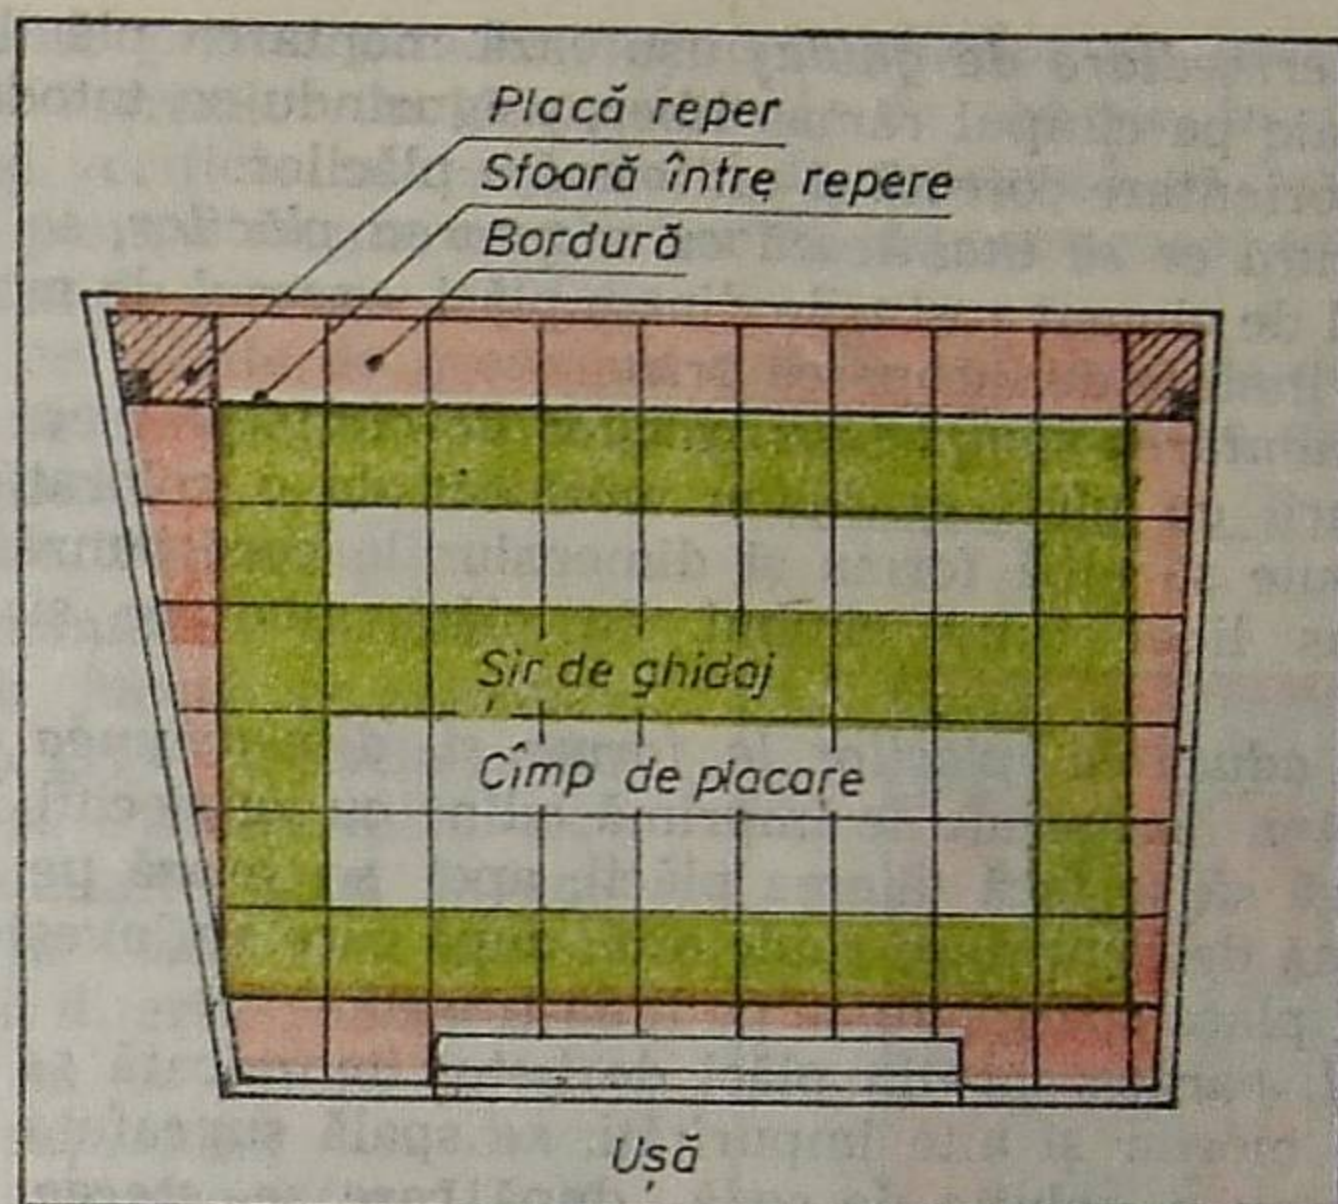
Trasarea și montarea plăcilor de beton mozaicat.
